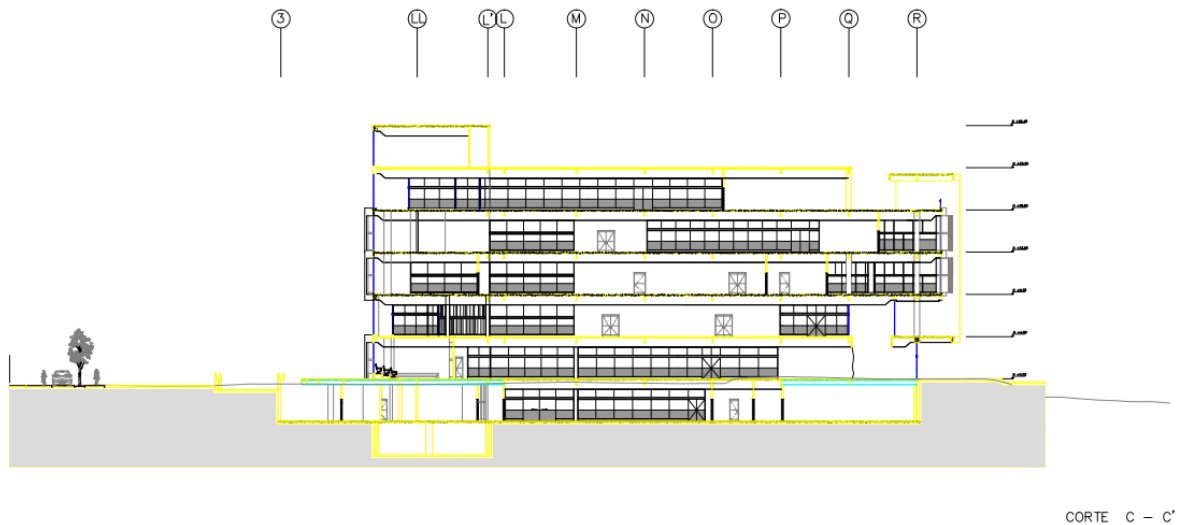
Corte Edificio Bloque 2 Clúster de la Tierra, Yachay. Fuente: Planos Arquitectónicos Proyecto Yachay
